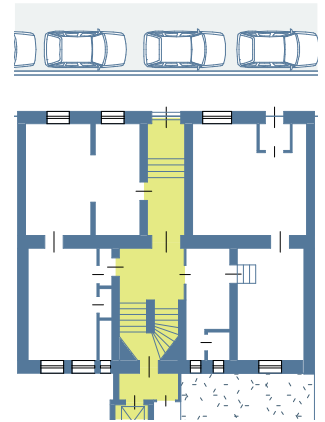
Grundriss eines Gründerzeithauses mit einem mittig situierten Eingang
